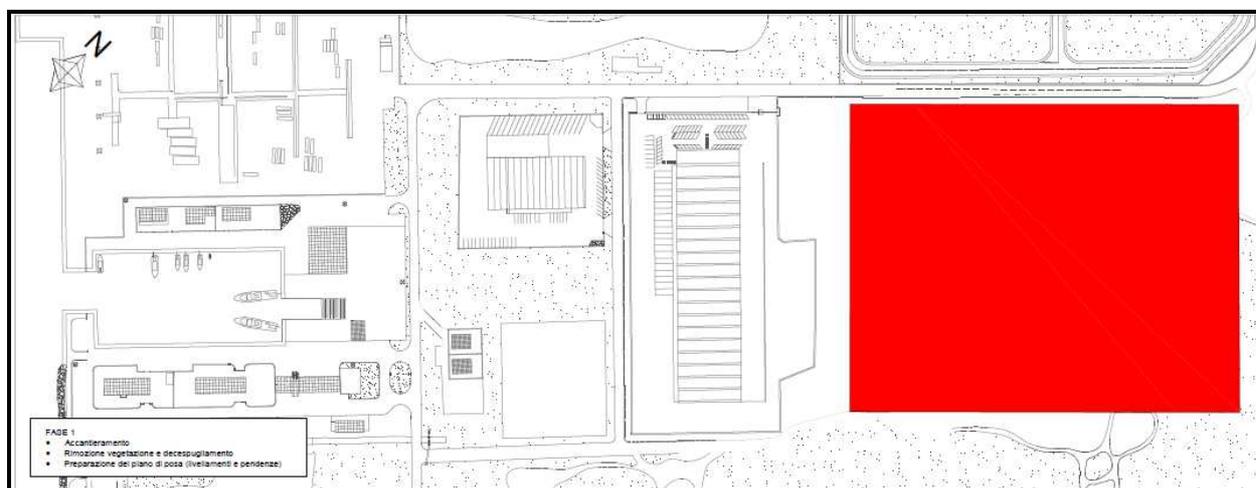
Fase 1. Area oggetto delle lavorazioni previste.
